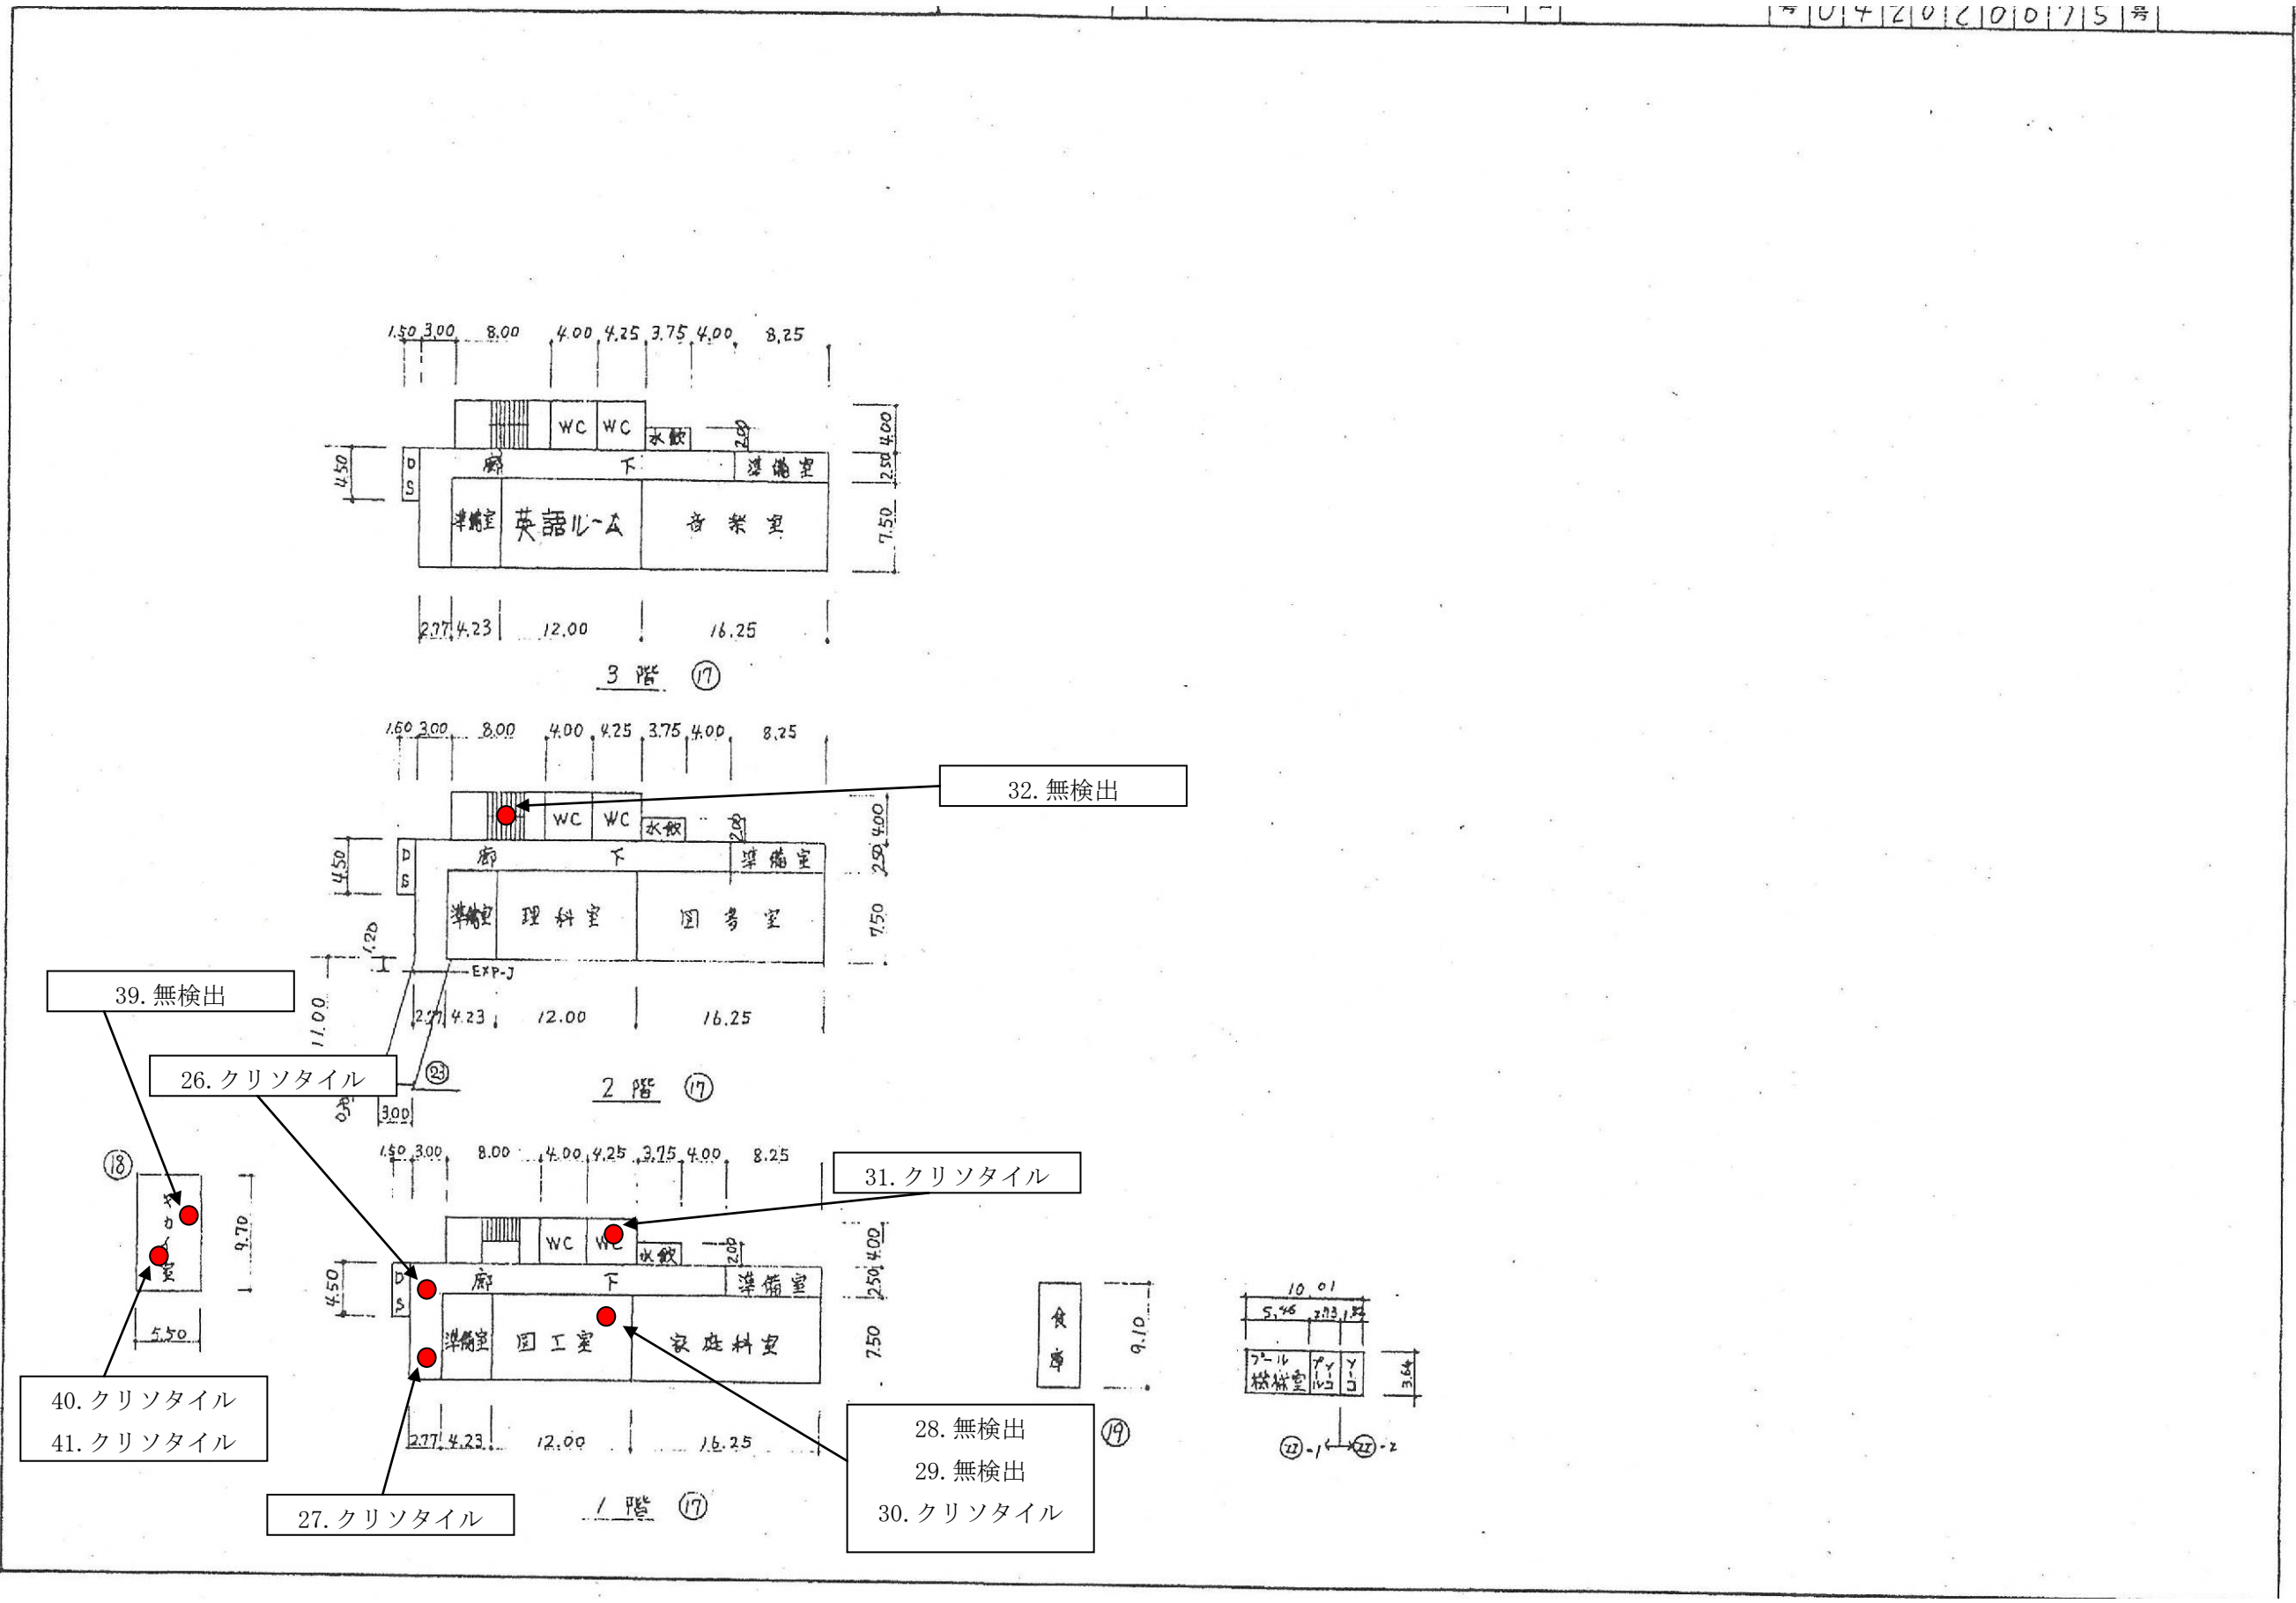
旧門脇小学校採取箇所図③ (教室棟平面図)
